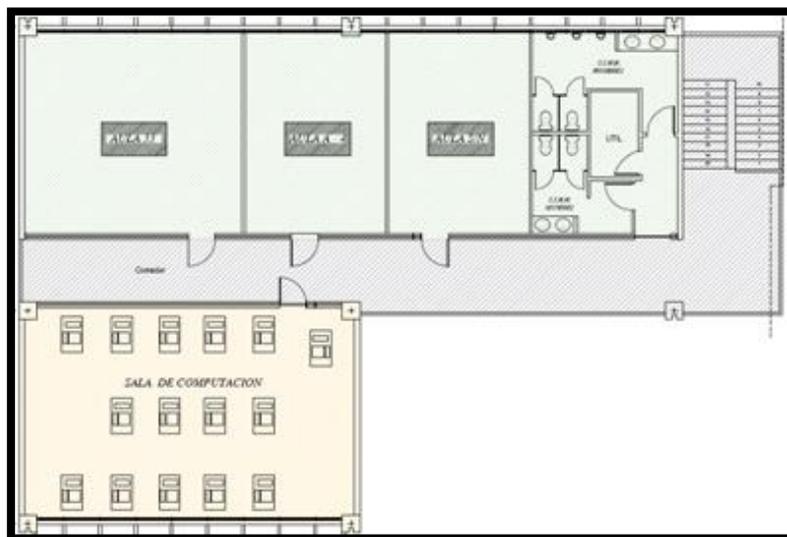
Extintores, Planta alta, Edificio 24-D, Zona 3
